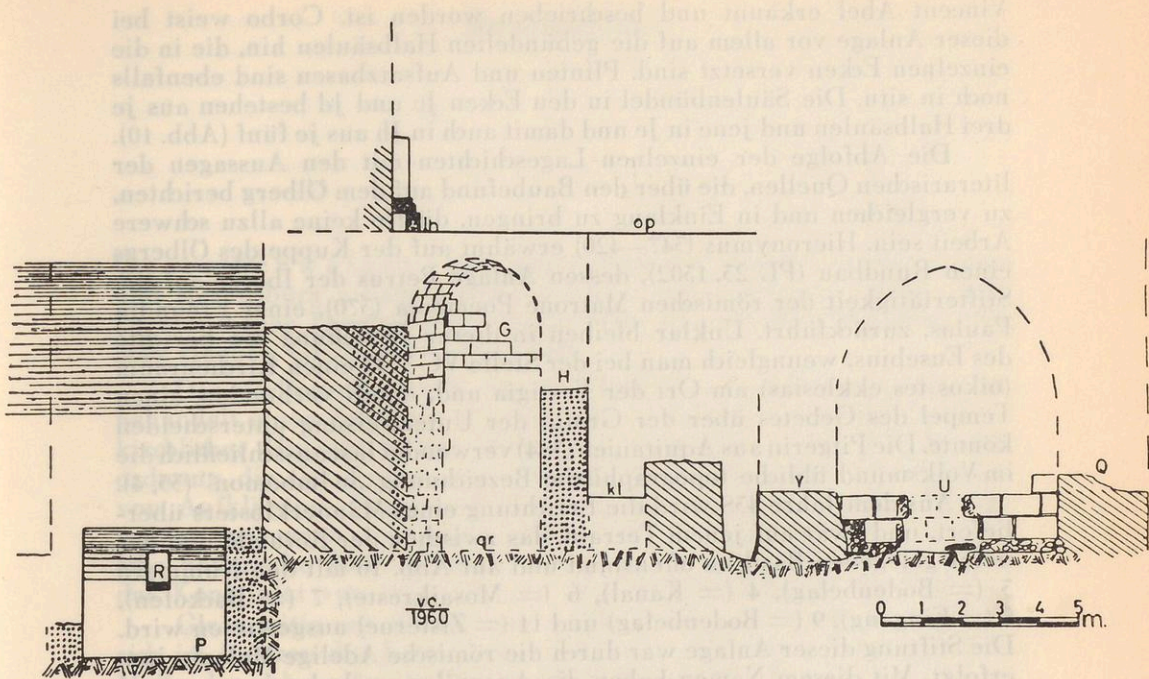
Jerusalem: Ölberg, Schnitt A—B (vgl. Plan I).
